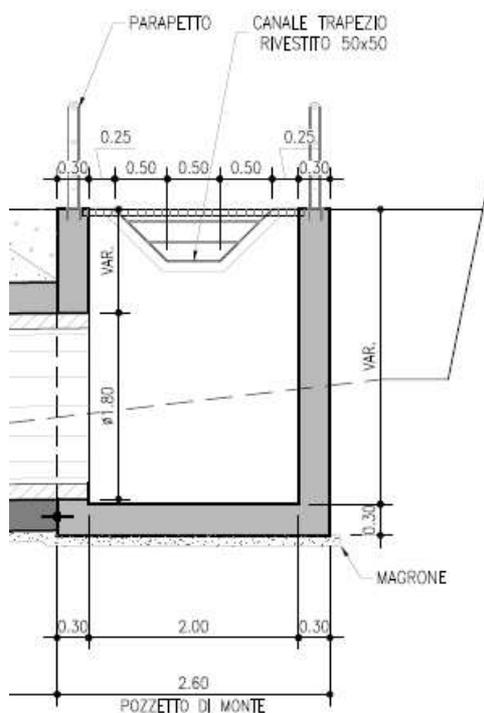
Manufatto d'imbocco - Sezione longitudinale
